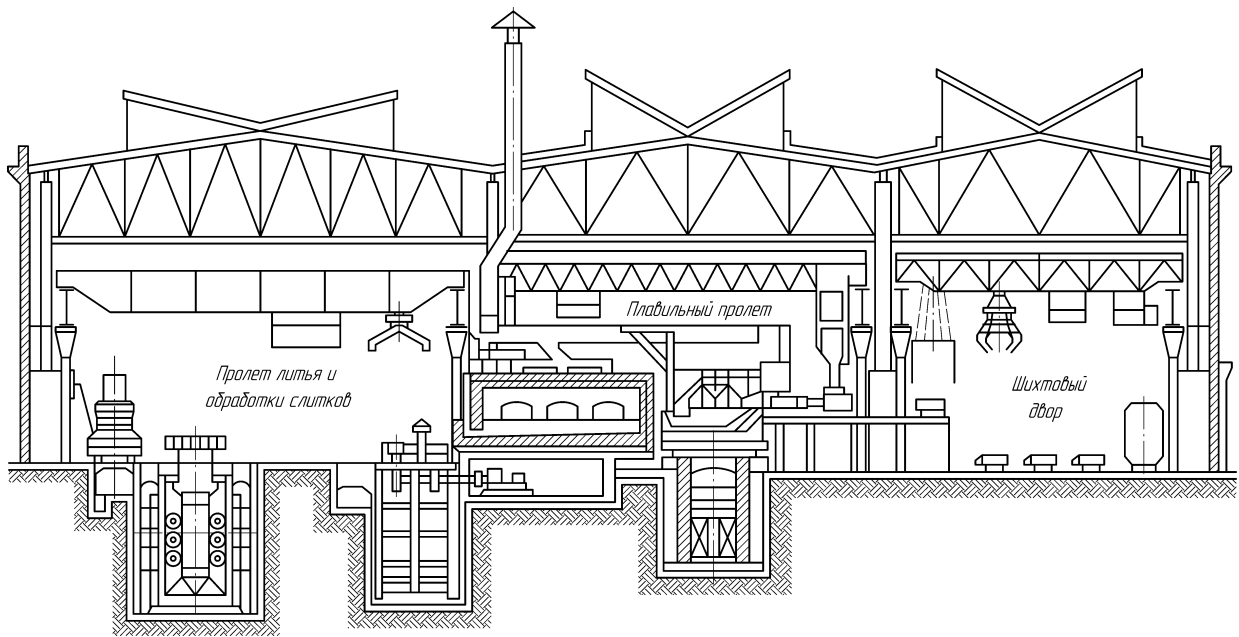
Поперечный разрез литейного цеха заготовительного литья
